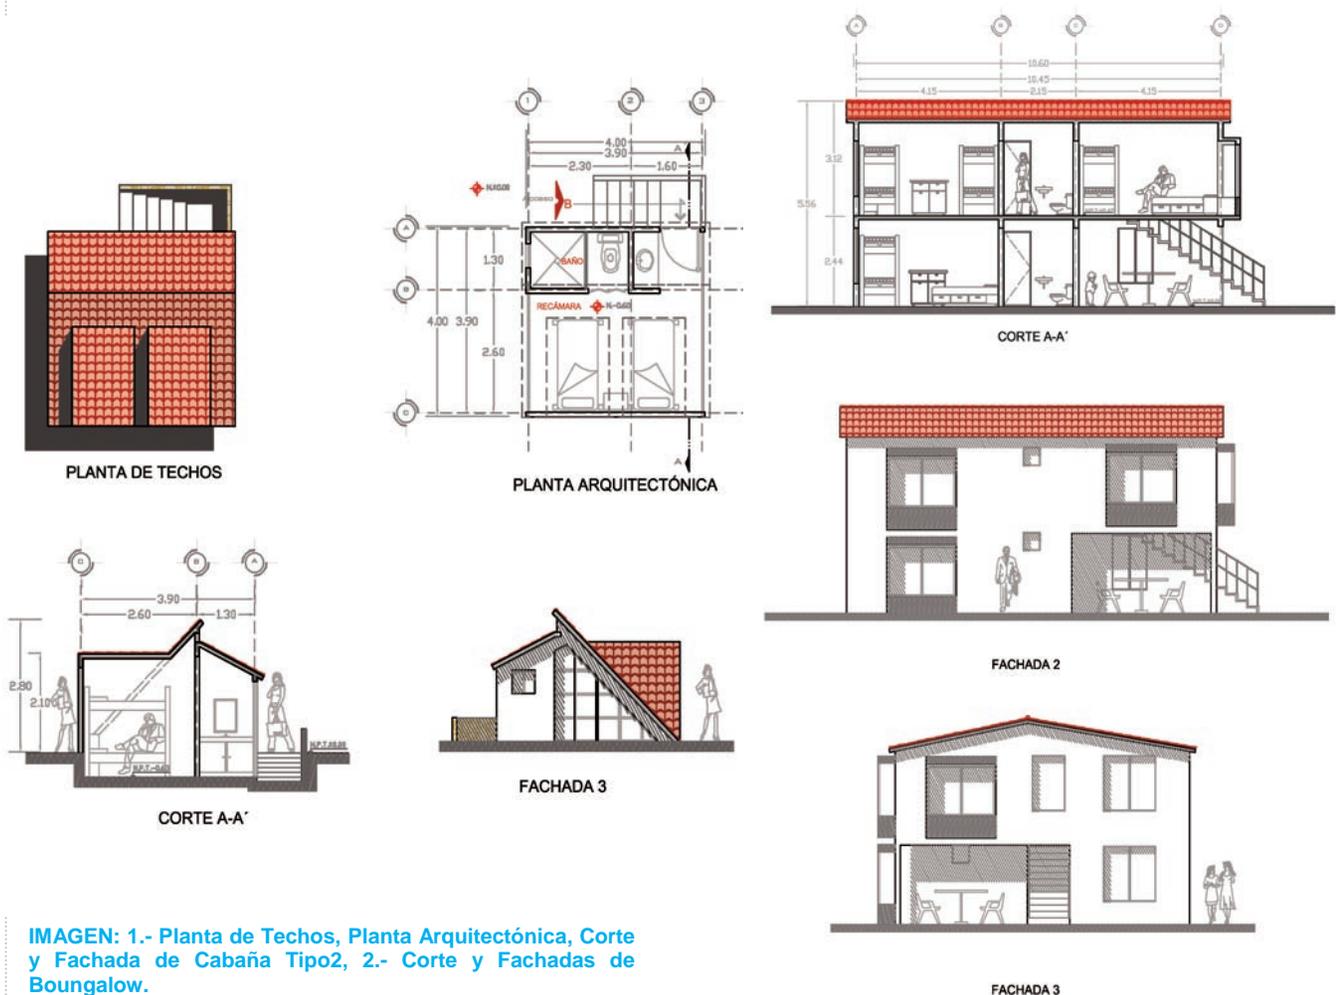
Planta de Techos, Planta Arquitectónica, Corte y Fachada de Cabaña Tipo2, 2.- Corte y Fachadas de Boungalow.
